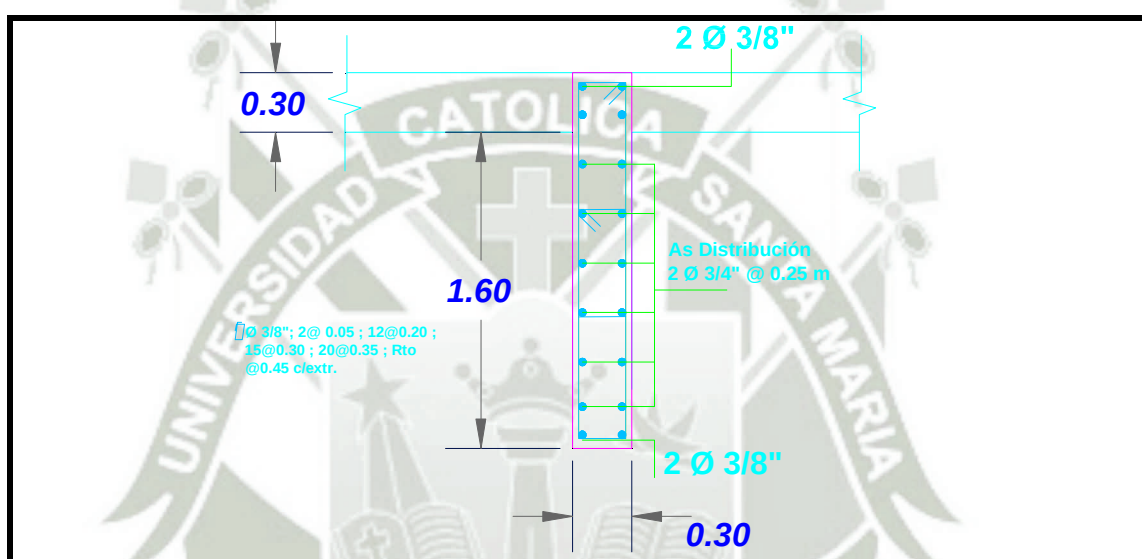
Diseño en Concreto Armado – Viga Diafragma del Tablero de Puente
